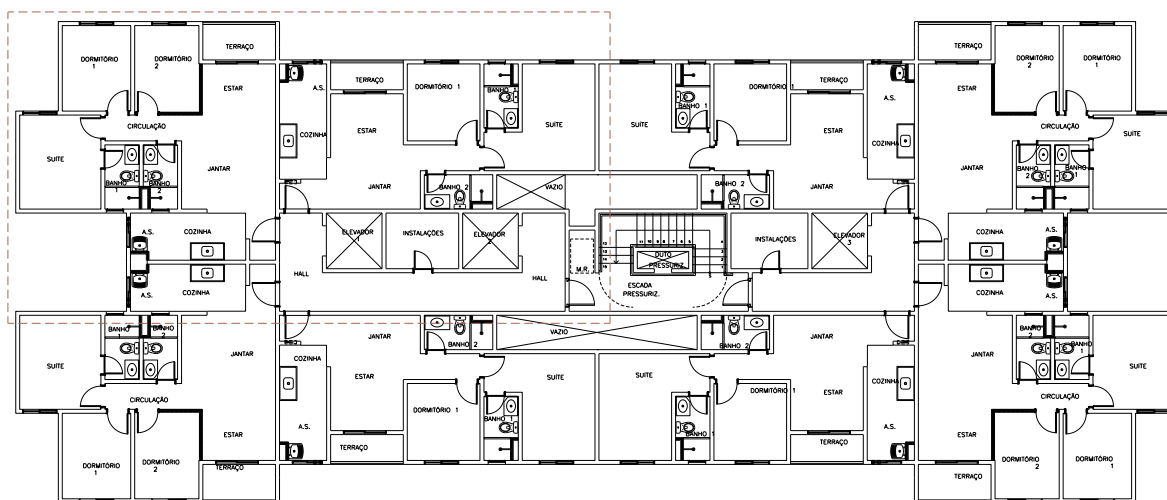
Edifício Vita Belle: planta arquitetônica do pavimento tipo
